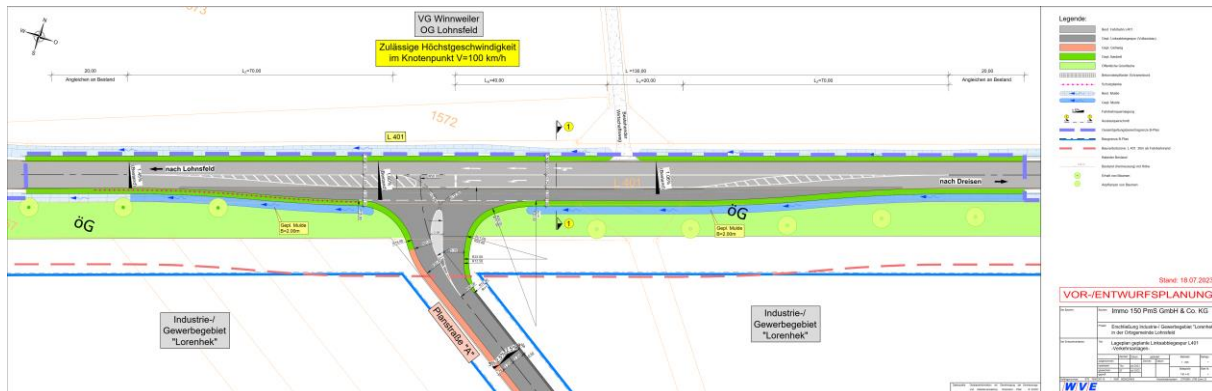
Vor-/Entwurfsplanung Lageplan geplante Linksabbiegespur L 401 - WVE GmbH Kaiserslautern, Stand 06/2023
